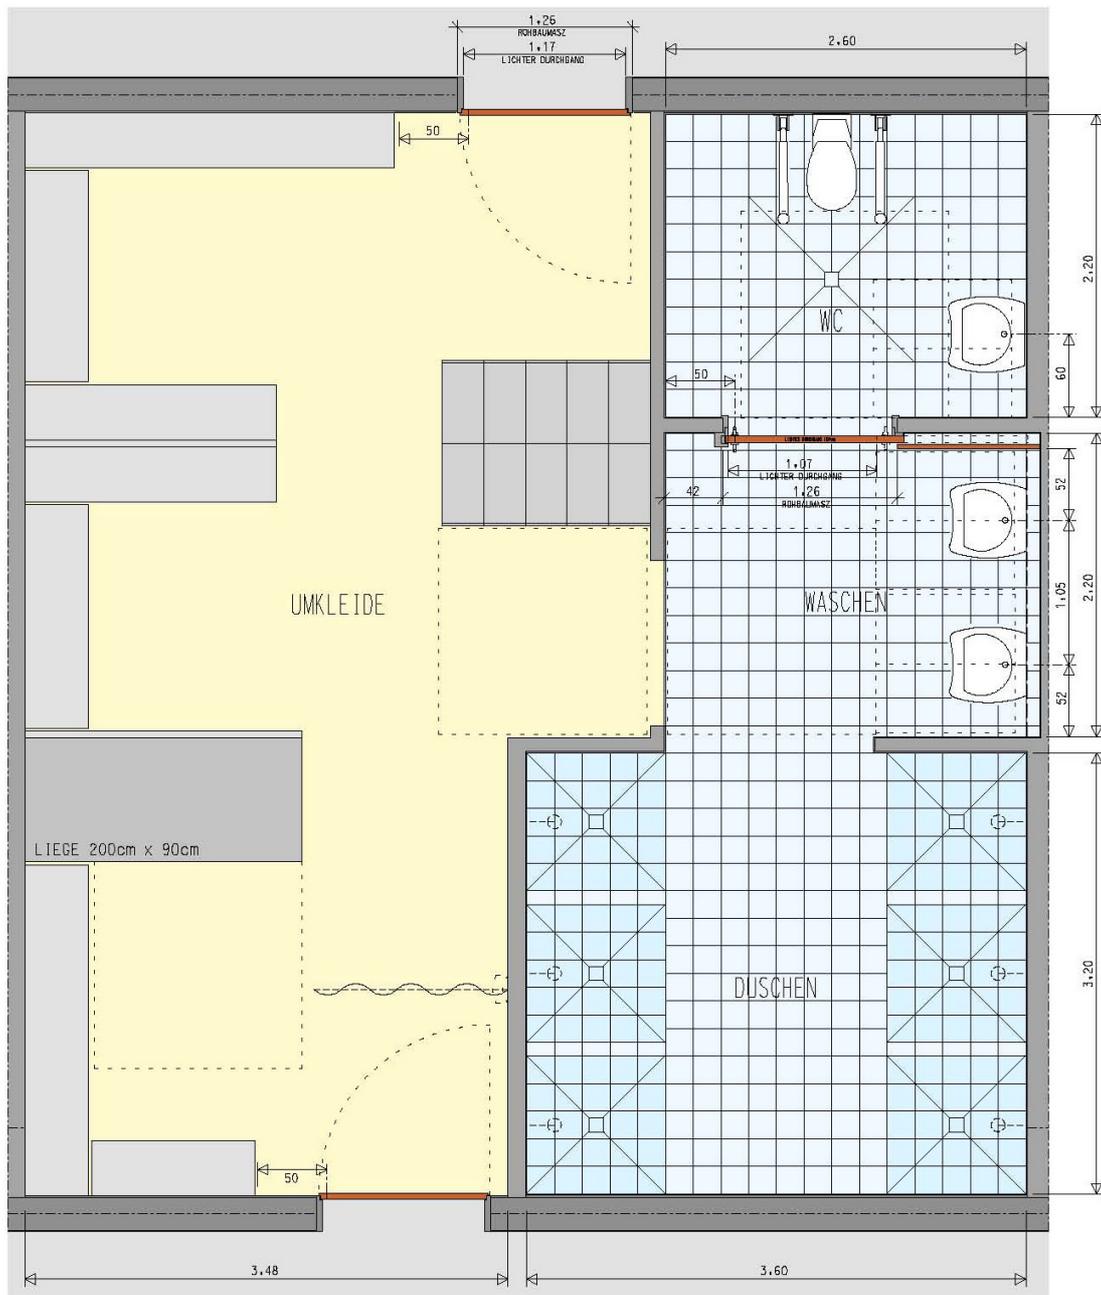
Beispiel: Zweifach / Dreifach-Sporthalle nach DIN 18032-1 und DIN 18040-1 mit einer Raumeinheit Umkleide und Sanitärblock (Dipl.-Ing. M. Bruckner).
